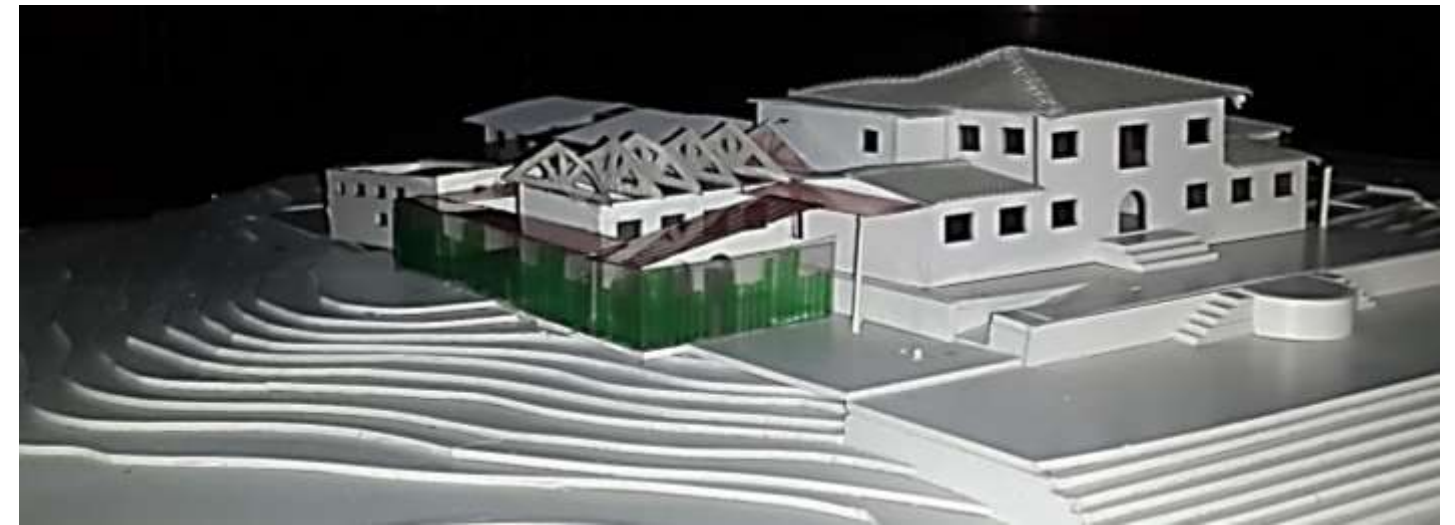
Perspectiva proyecto: muro-techos- estructura vista
